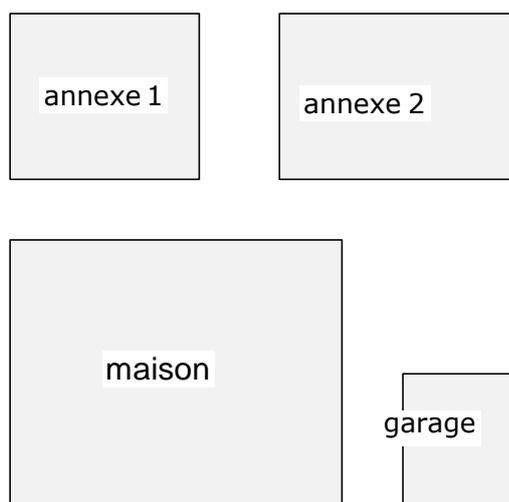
exemple d'un bâtiment de forme complexe se composant de sous-structures indépendantes
